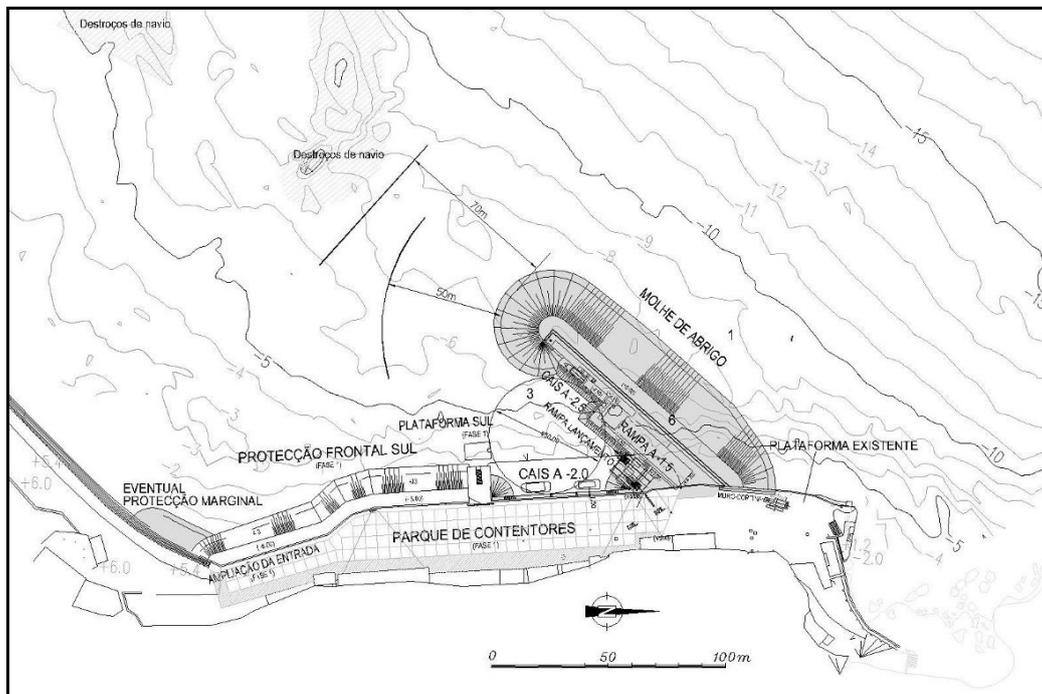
Planta de arranjo geral da Fase 2 (solução A)
